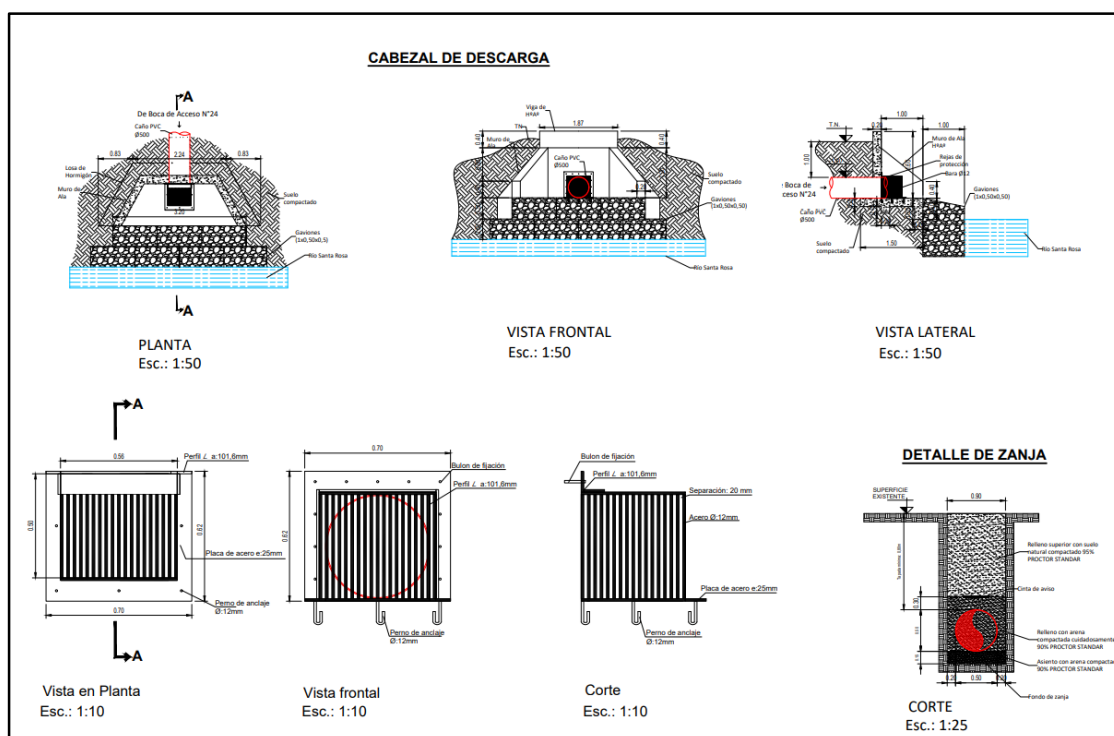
DETALLES DE LA OBRA DESCARGA SOBRE EL RÍO SANTA ROSA.
